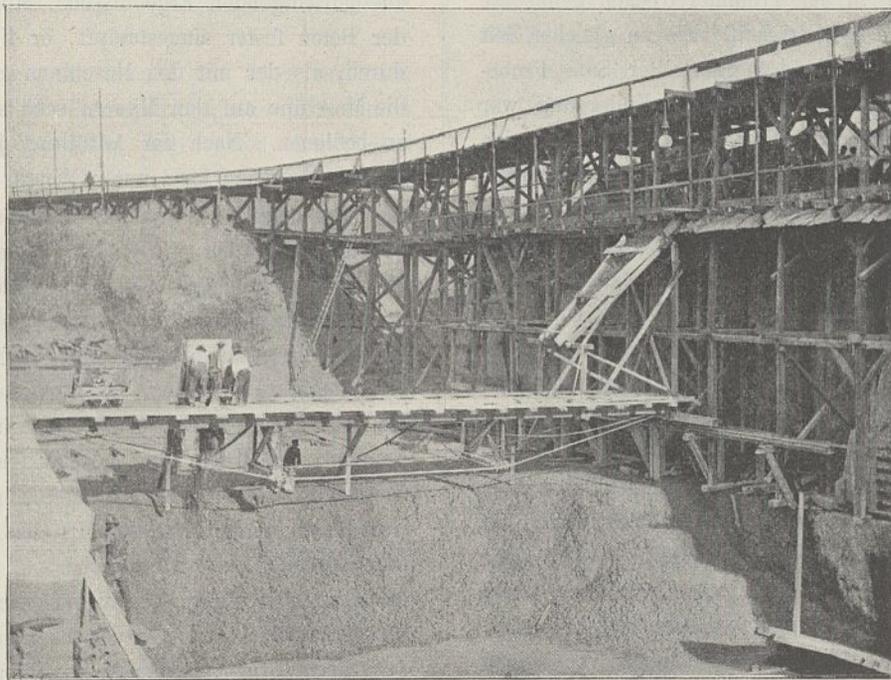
Herstellung des Betonbettes der Schleusen-kammer-Schlen.
